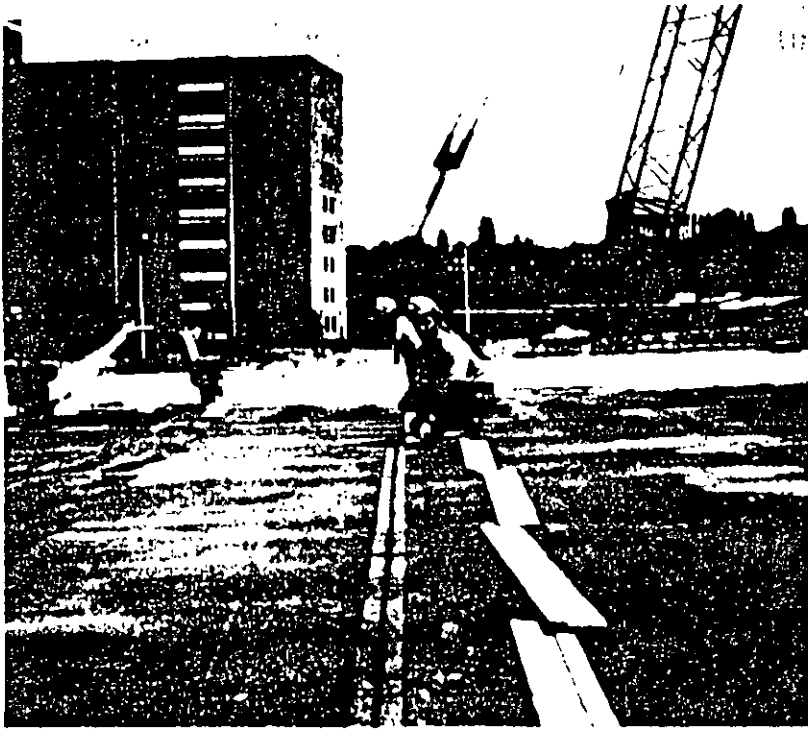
En losas sobre el terreno, las juntas de contracción hechas con herramienta en el hormigón fresco, proporcionan un plano débil que evita el agrietamiento arbitrario causado por contracción de fraguado o cambios de temperatura.
